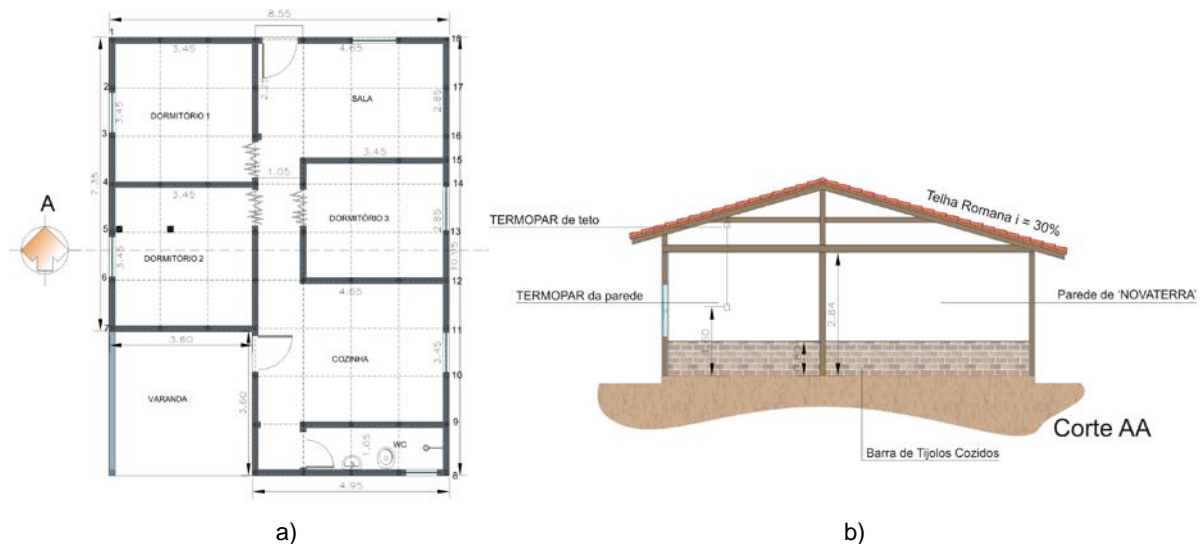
Casa de Caldas: a) planta arquitetônica; b) localização dos sensores
